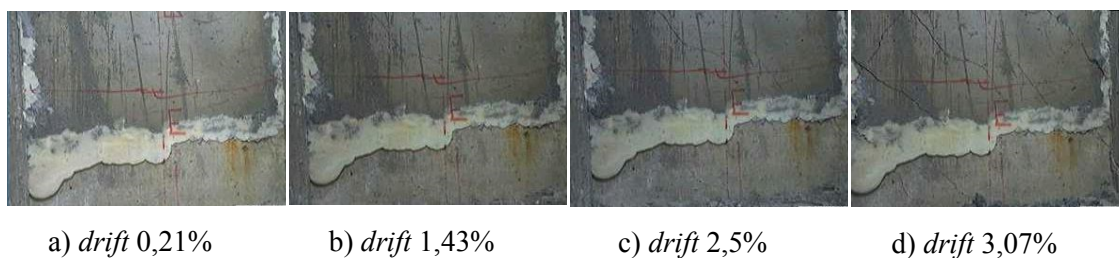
Evolução dos danos no pilar PO2-N6-R1, vista interior da face Este.
